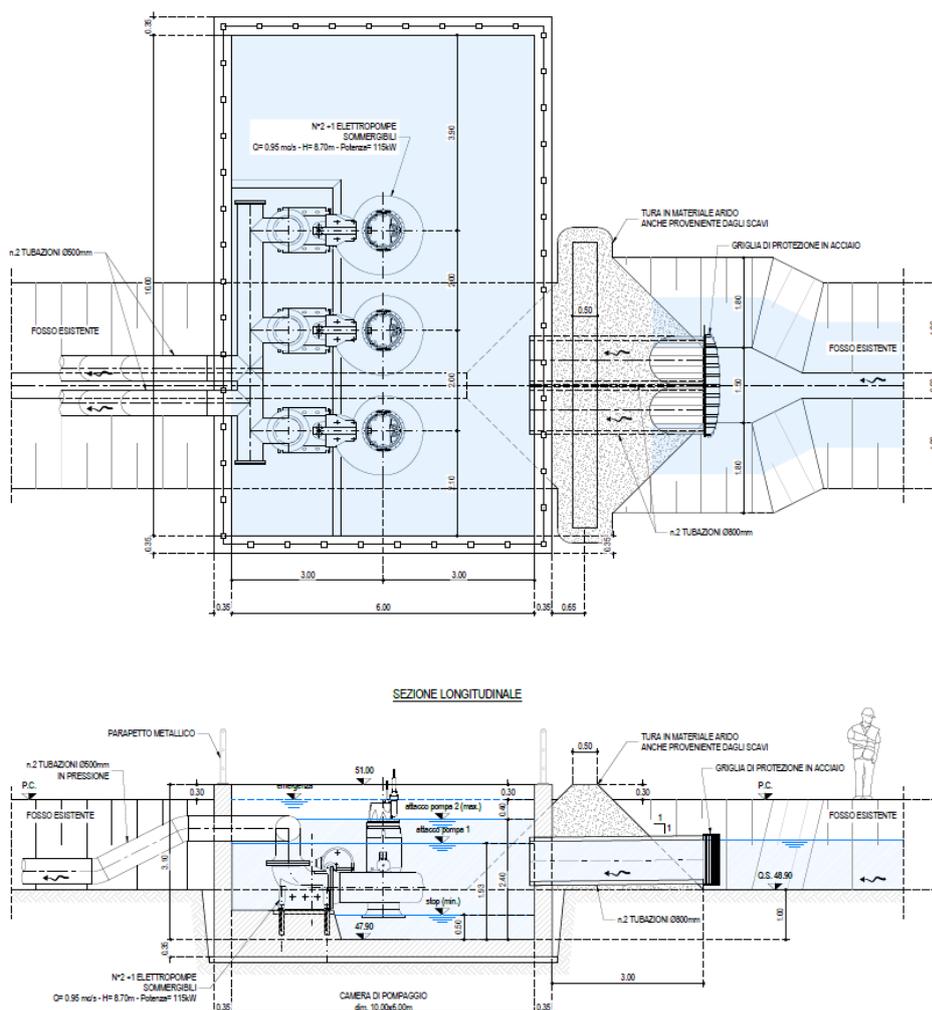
Pianta e sezione impianto di sollevamento provvisorio
